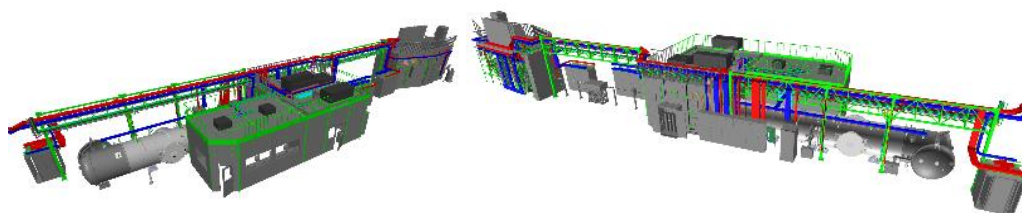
Vistas da versão final do projeto executivo de infraestrutura da linha SAPUCAIA.
